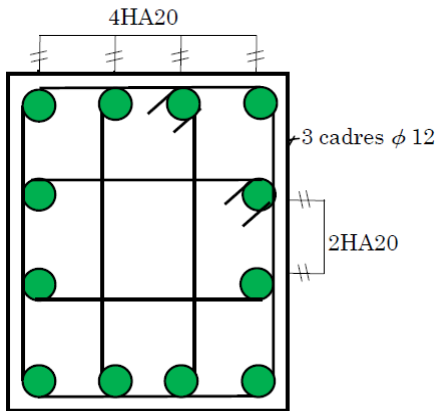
Schéma de ferrailage des poteaux RDC et 1^{er}, 2^{ème} étage
